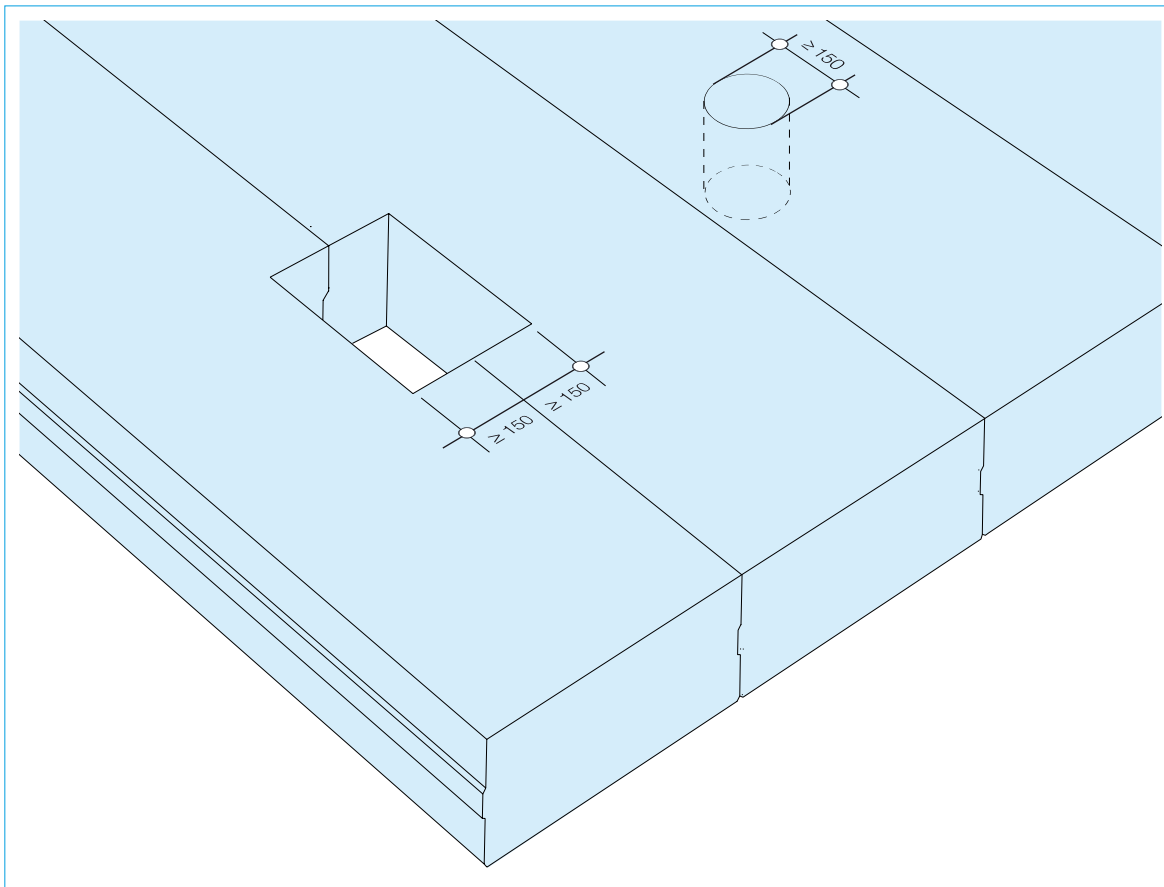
Maximale Abmessungen runder und rechteckiger Durchbrüche in Porenbeton-Dachplatten. Die Ausbildung rechteckiger Aussparungen in gegenüberliegenden Dachplatten ist in bauaufsichtlichen Zulassungen geregelt
